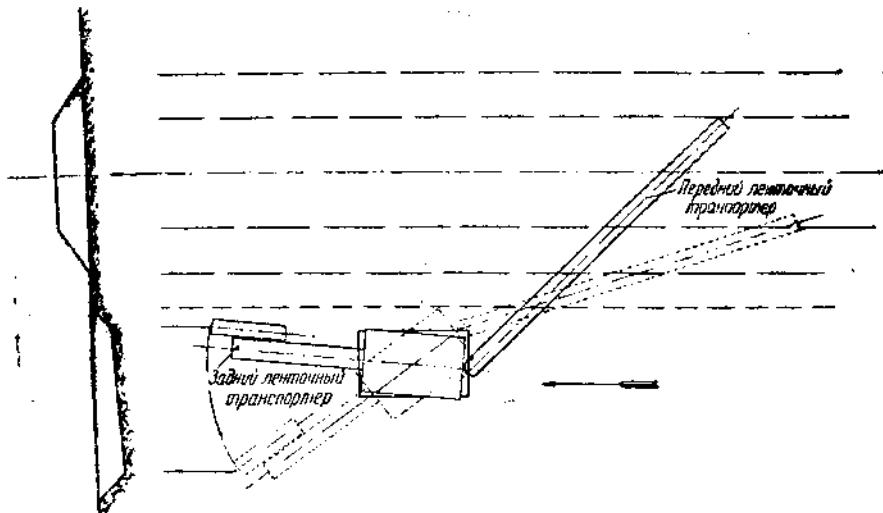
Схема работы фрезерного экскаватора при возведении насыпи из резерва
